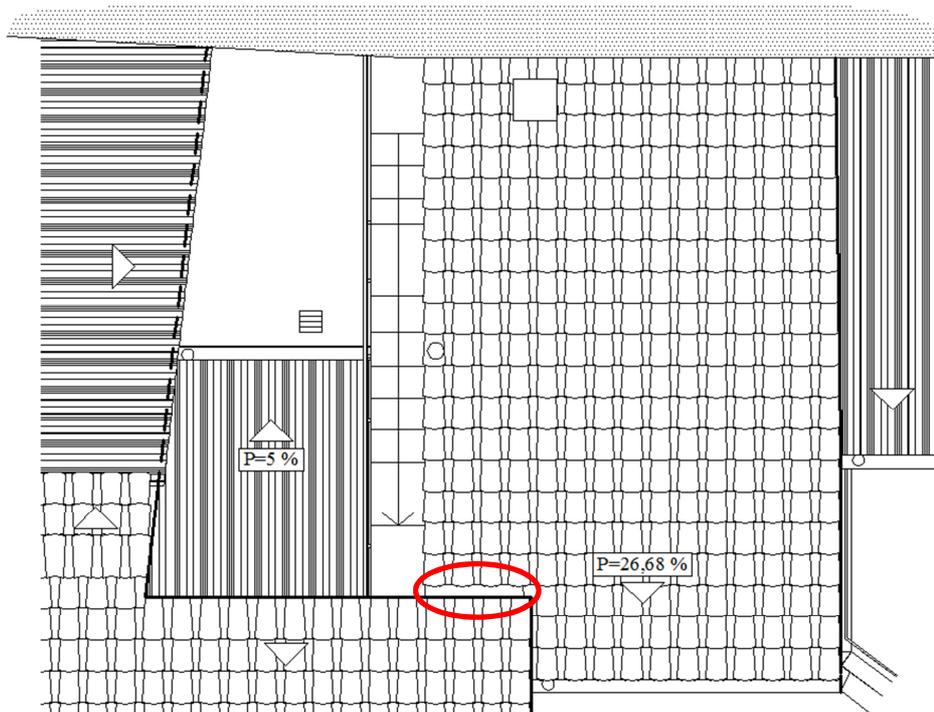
Situación de la humedad. Cubiertas de la vivienda objeto distinguidas de las cubiertas anexas mediante una línea perimetral gruesa.
